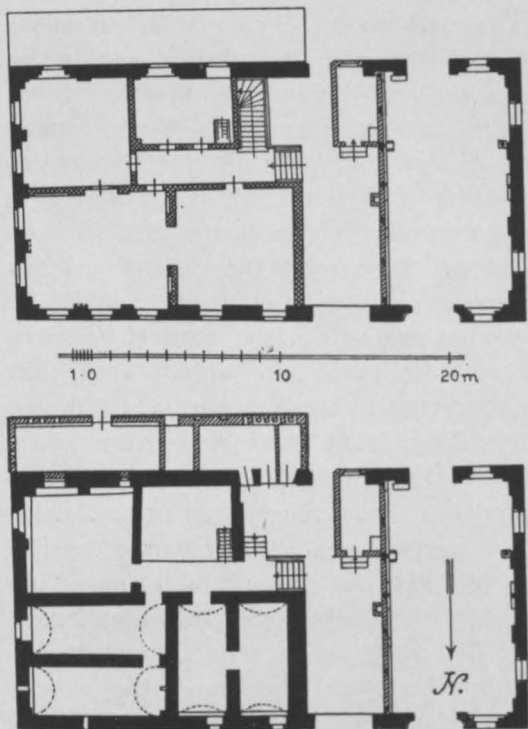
Finsterwalde. Rathaus. Grundrisse.
